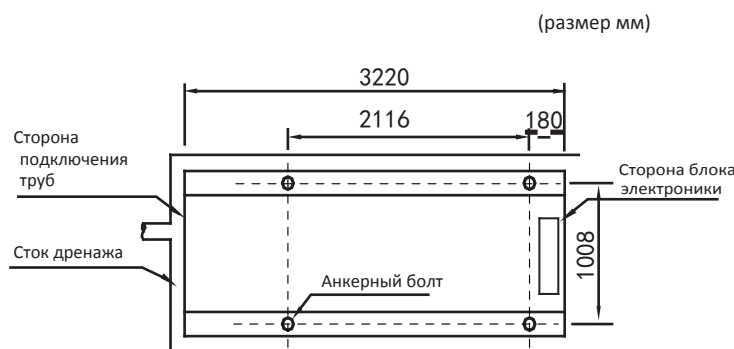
Вид сверху, принципиальная схема и установочные размеры MDC-SU90M-RN1L
